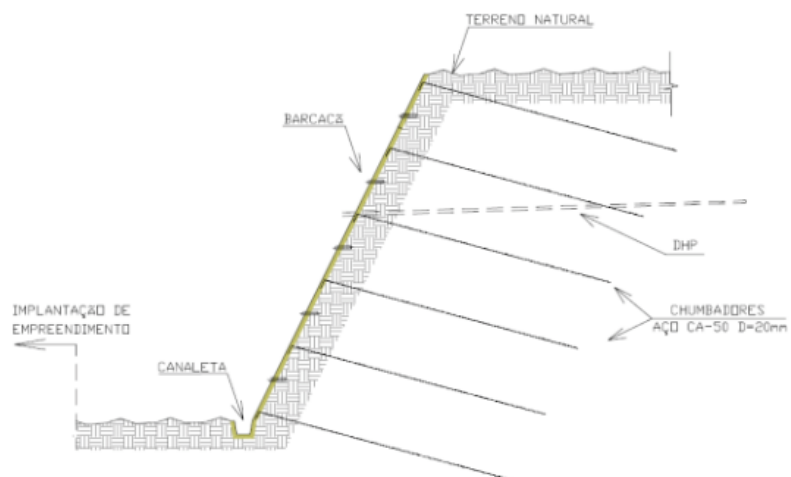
Seção transversal do modelo proposto para solo grampeado.
